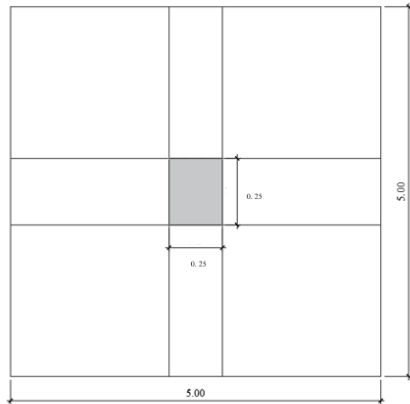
Zapata. Ver plano E02_Plano de cimentación eje Q.
